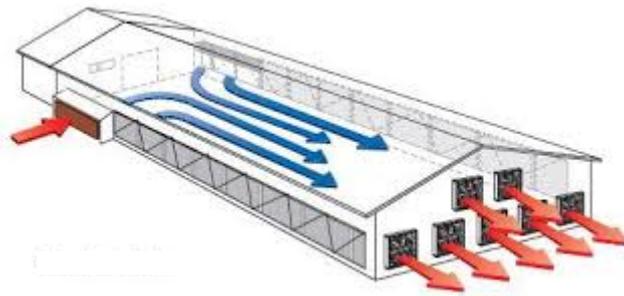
Panneaux d'évaporation avec ventilation type tunnel (Anonyme, 2010)
